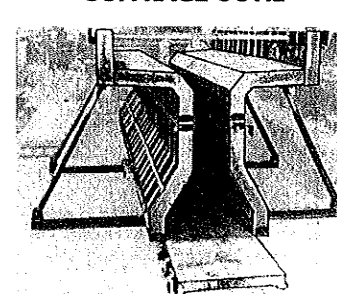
Coffrages métalliques pour poutres préfabriquées (stabilité des joues articulées en pied par des contrefiches à vérin). (doc. Deburaux.)
